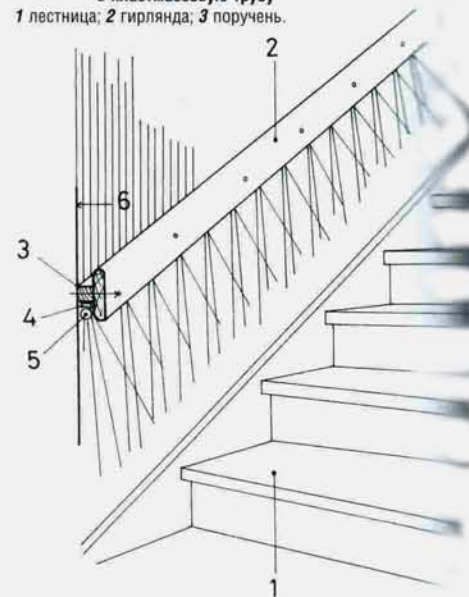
Лампа, установленная под поручнем, обеспечивает наиболее оптимальное освещение ходового участка лестницы
